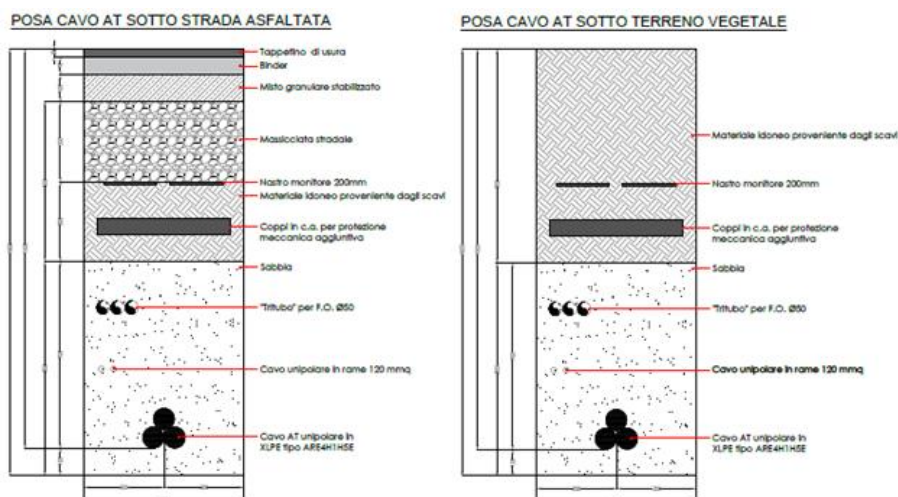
Sezione tipo scavi su strada asfaltata e terreno vegetale (1 terna di cavi) cavidotto per collegamento a RTN (esterno)
